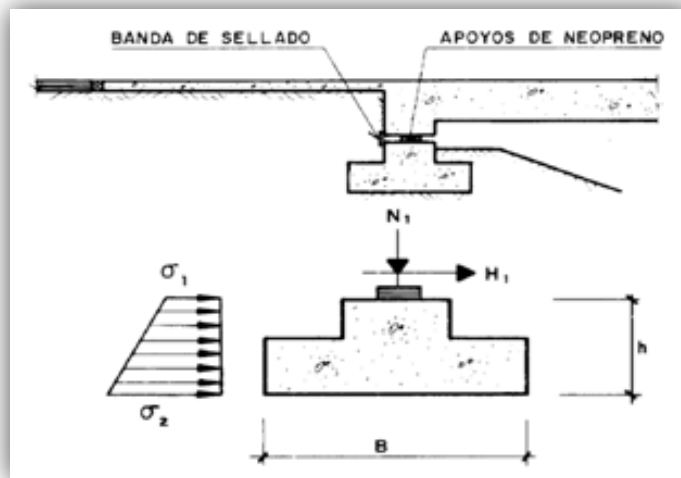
Fundación directa Estribo semi-integral. Esquema de cálculo para zapata
